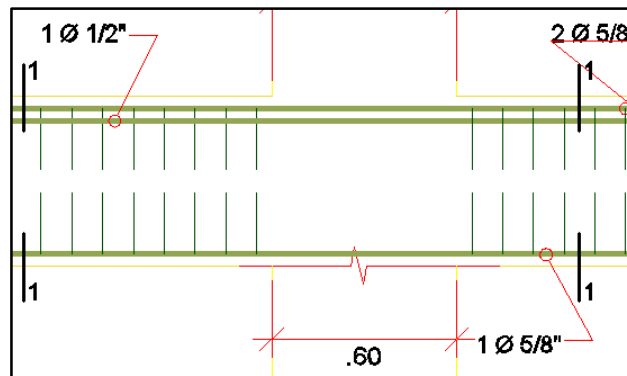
Dimensión de la columna paralela al refuerzo longitudinal de la viga
